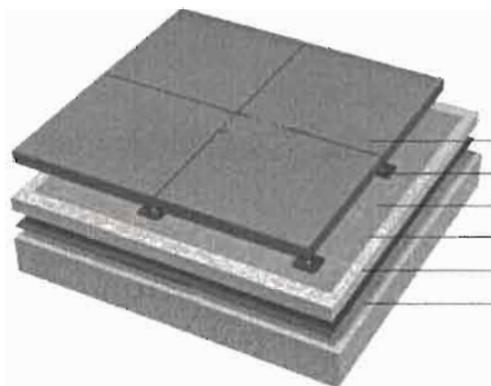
Устройство инверсионной кровли с покрытием из тротуарных плиток:
